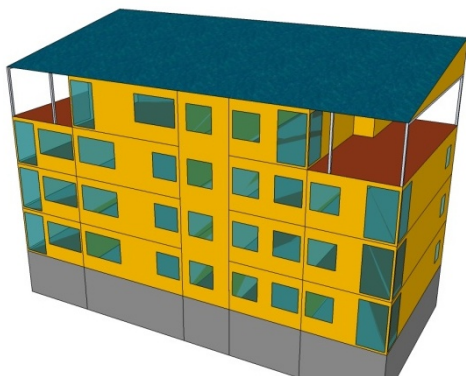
Südansicht des Mustergebäudes Mehrfamilienhaus Neubau mit Pultdachausführung
